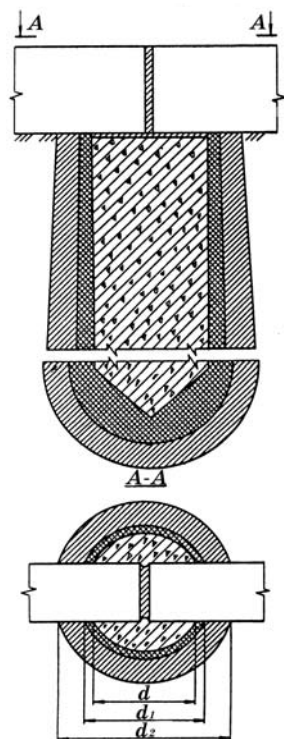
Конструктивная схема набивной сваи с расположением на ней балок или плит основания дома.
